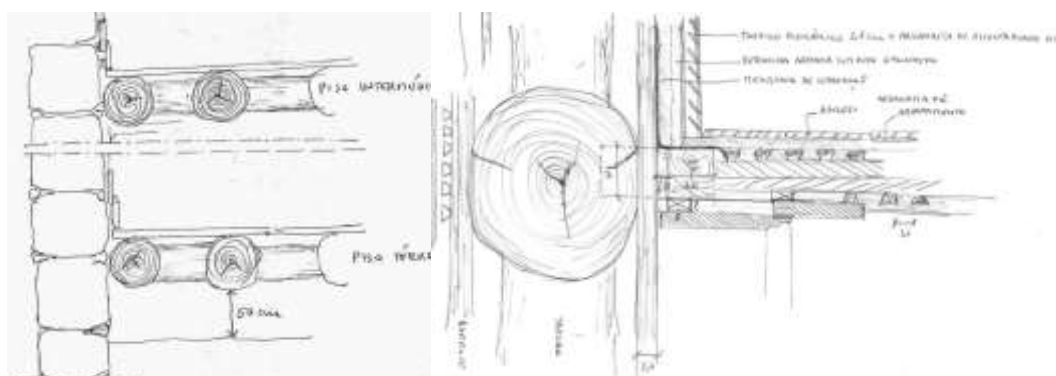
Corte de pavimentos: pormenorização do piso térreo e intermédio e do pavimento impermeável interior (Teixeira).
